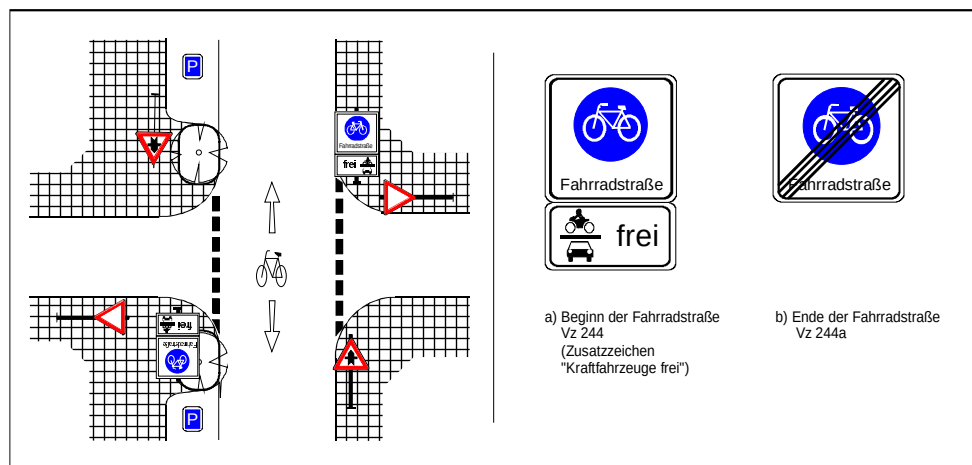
Beschilderung einer Fahrradstraße, hier mit Vorrang der Nebenstraße
